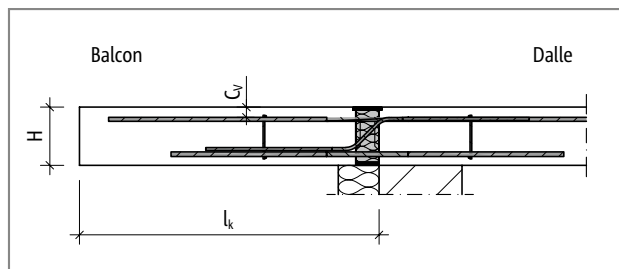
Schöck Isokorb® T Type K-M13 : Système statique
